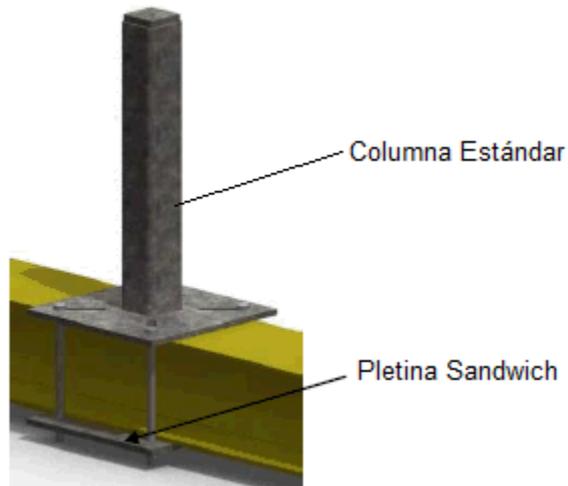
Sistema de anclaje a la estructura existente. Fuente TRACTEL.
